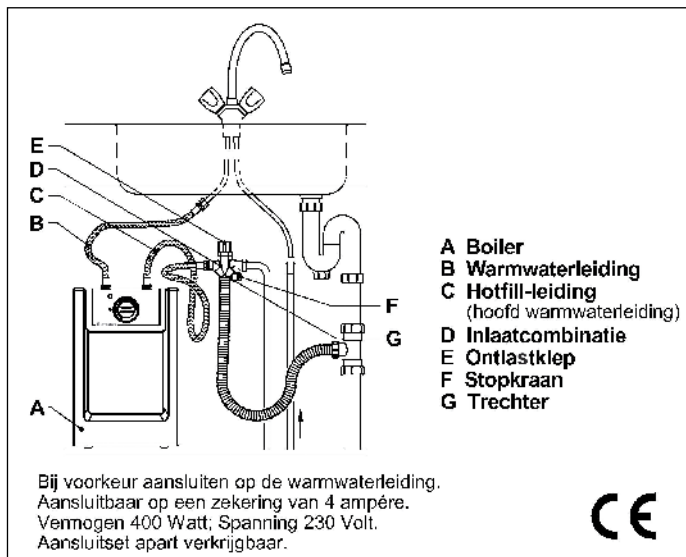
Inventum Q10 Hotfill keukenboiler
